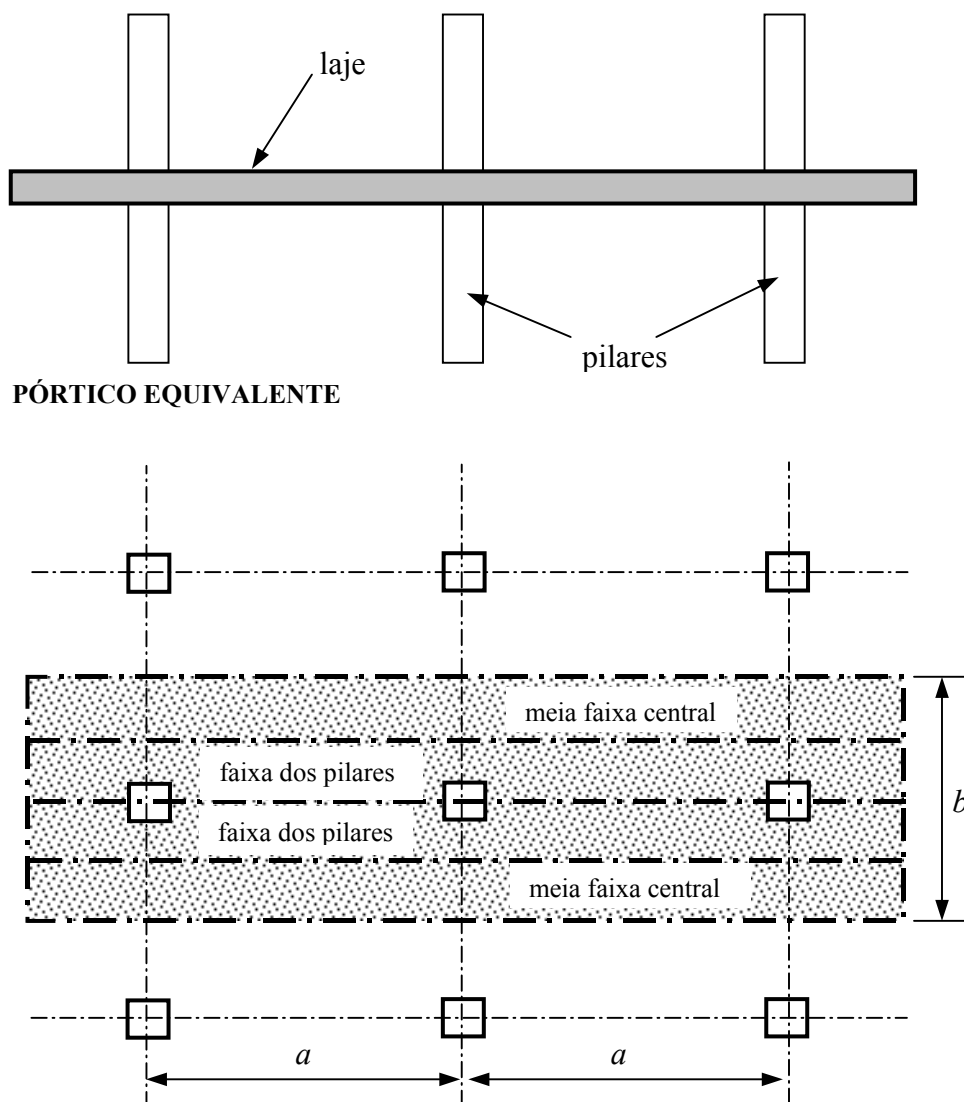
Pórtico equivalente em uma laje cogumelo.
